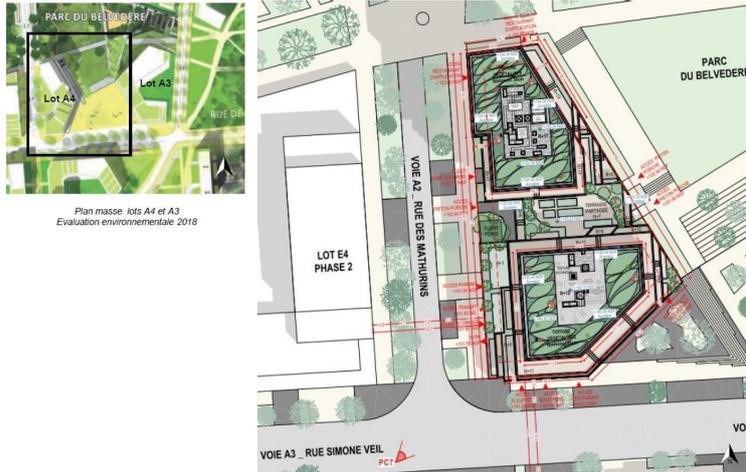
Plan masse du lot A3 p.162 étude d'impact
